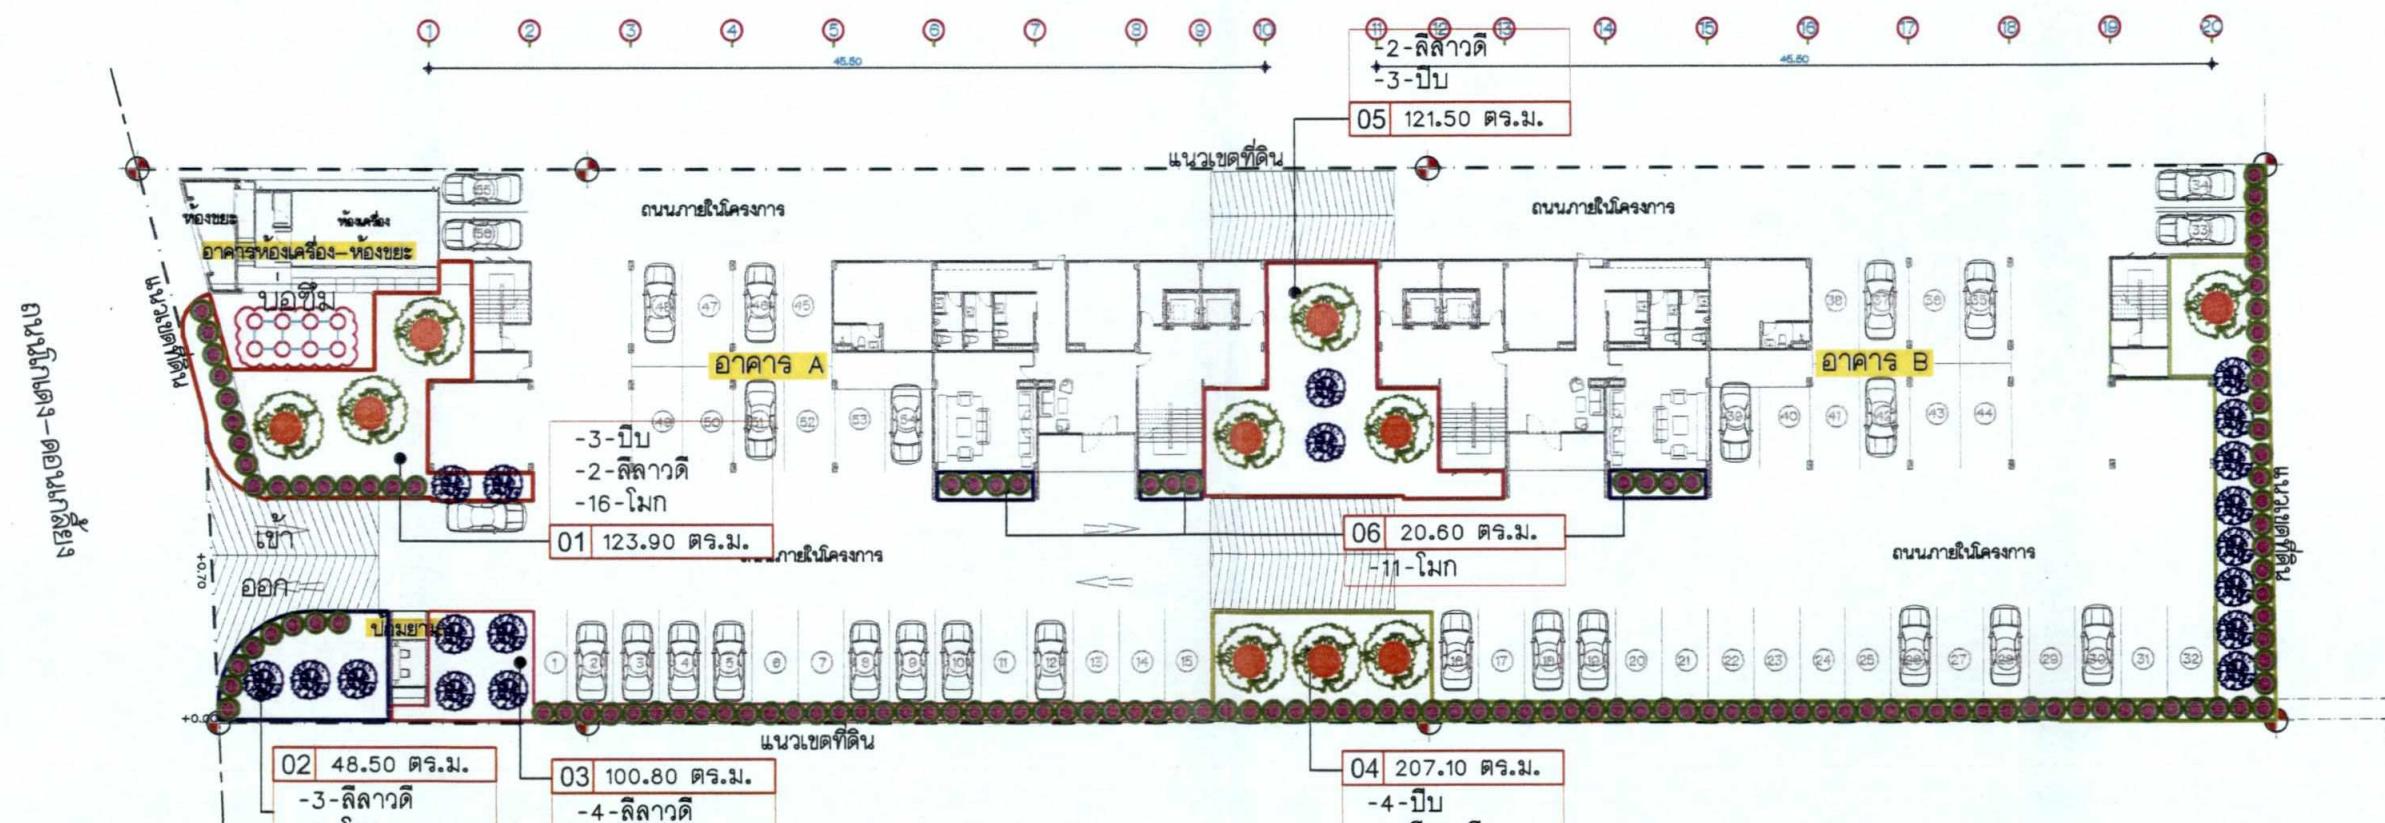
ผังพื้นที่สีเขียวรวมของโครงการ
